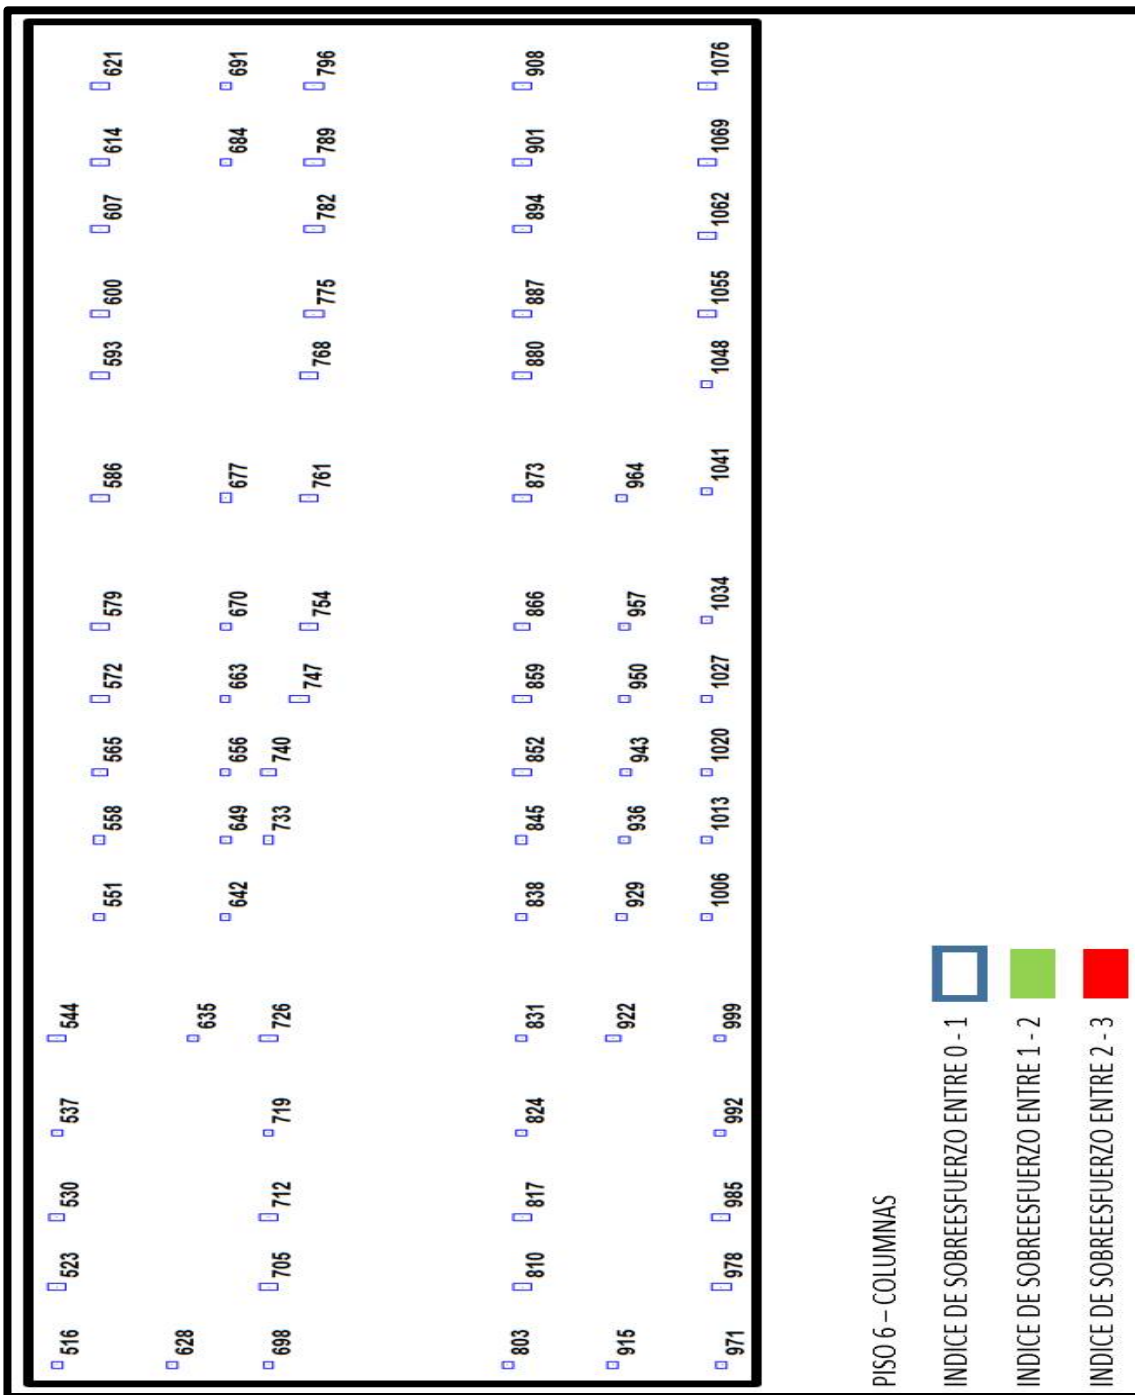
Sobre esfuerzos columnas piso 6. Fuente: Los autores
